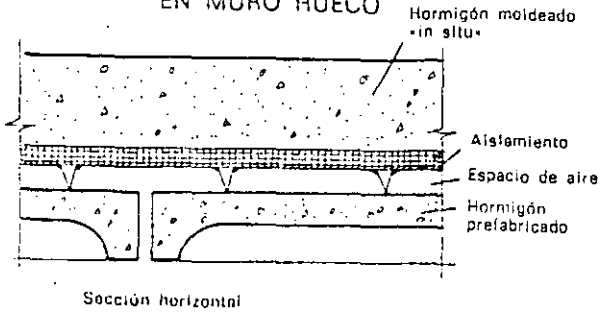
RECUBRIMIENTOS PREFABRICADOS DE PILARES UTILIZADOS COMO ENCOFRADO
